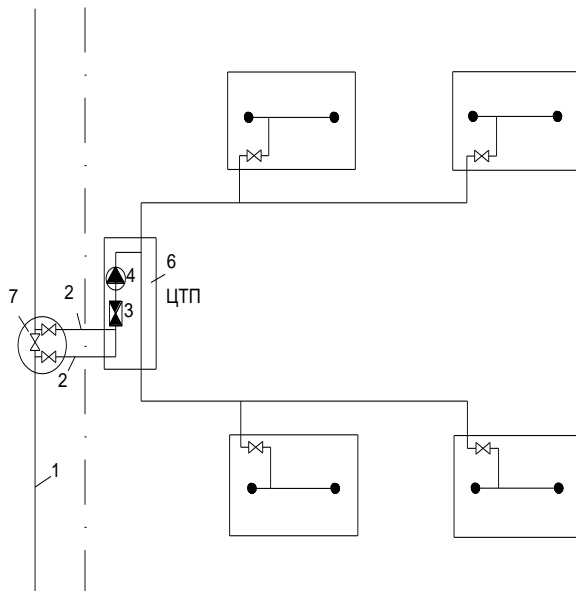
Трассировка при свободной планировке жилых кварталов с прокладкой внутриквартальной сети отдельно в грунте:
